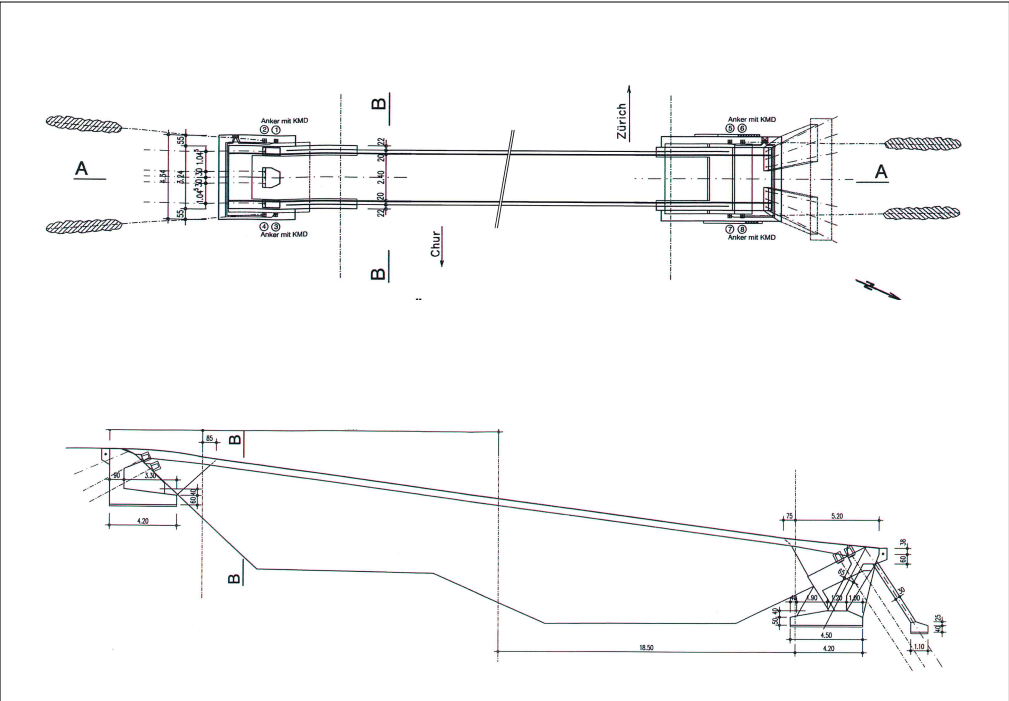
Grundriss und Längsschnitt, 2014
